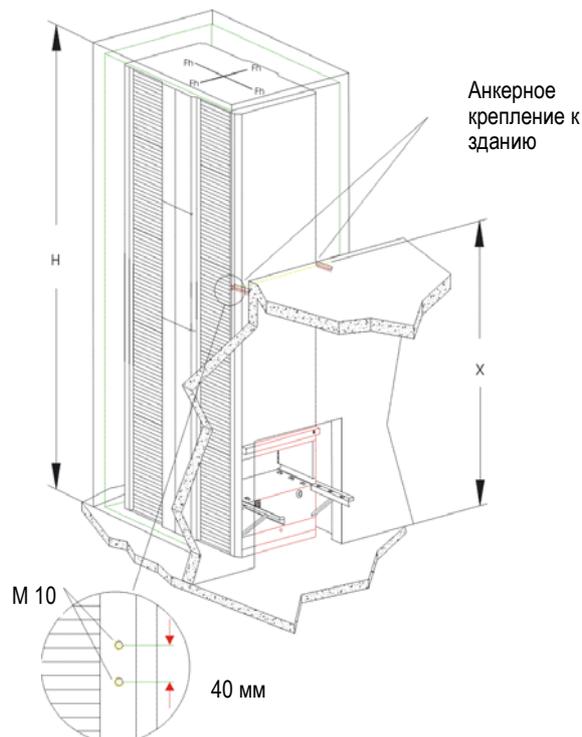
Пример крепления: анкерное крепление к междуэтажному перекрытию
